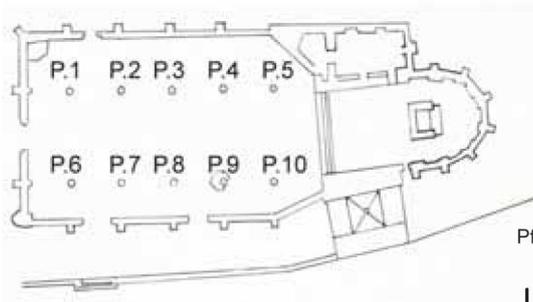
Meran, Pfarrkirche St. Nikolaus. Grundriss. Bild: Egg 1970, S. 110.
